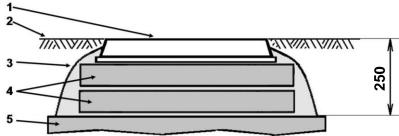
Расстояние от перекрытия колодца до уровня земли (асфальта) на тротуаре и газоне должно быть – не менее 250 мм:
